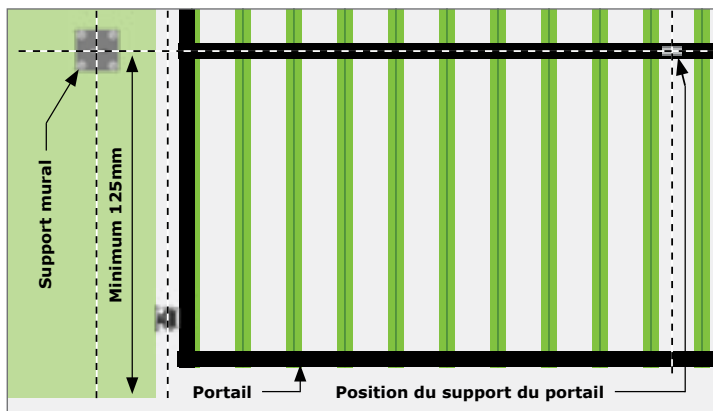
HAUTEUR DU SUPPORT MURAL
